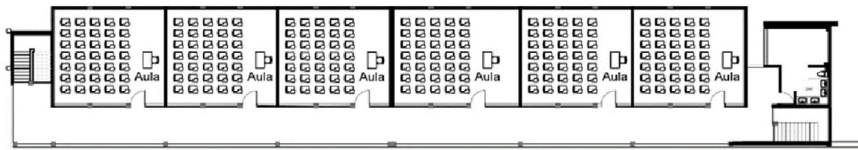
Planta arquitectónica baja de la Escuela Primaria Miguel Hidalgo y Costilla.
